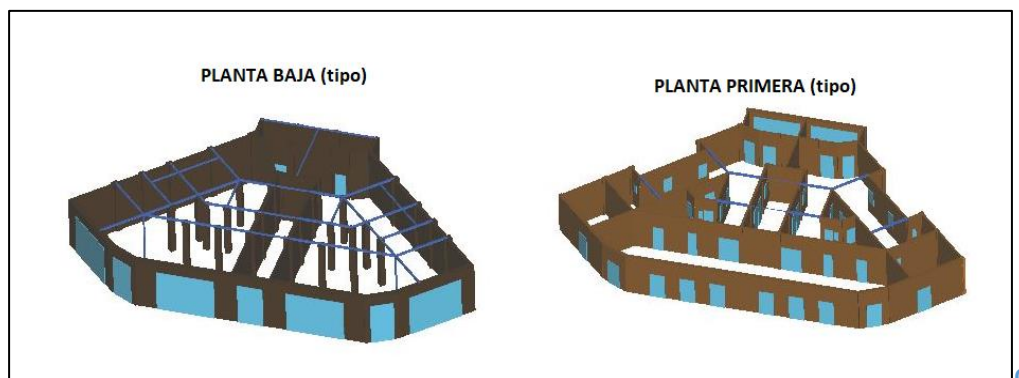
Plantas tipo MC161 (Fuente: Propia)
